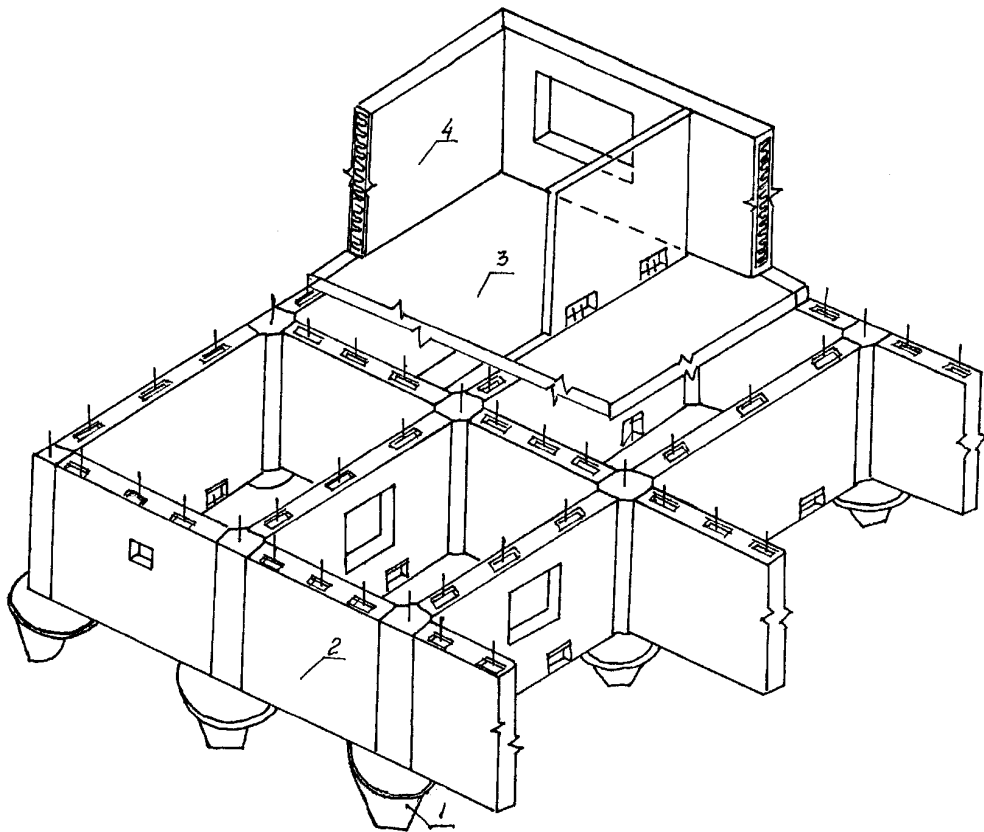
Infrastructura prefabricată; 1-elemente de talpă prefabricate; 2-panou elevație; 3-planșeu; 4-element de suprastructură;
